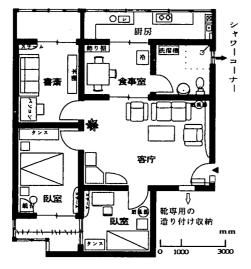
調査対象住宅の平面図 (タイプ 3 約 90 m²)
